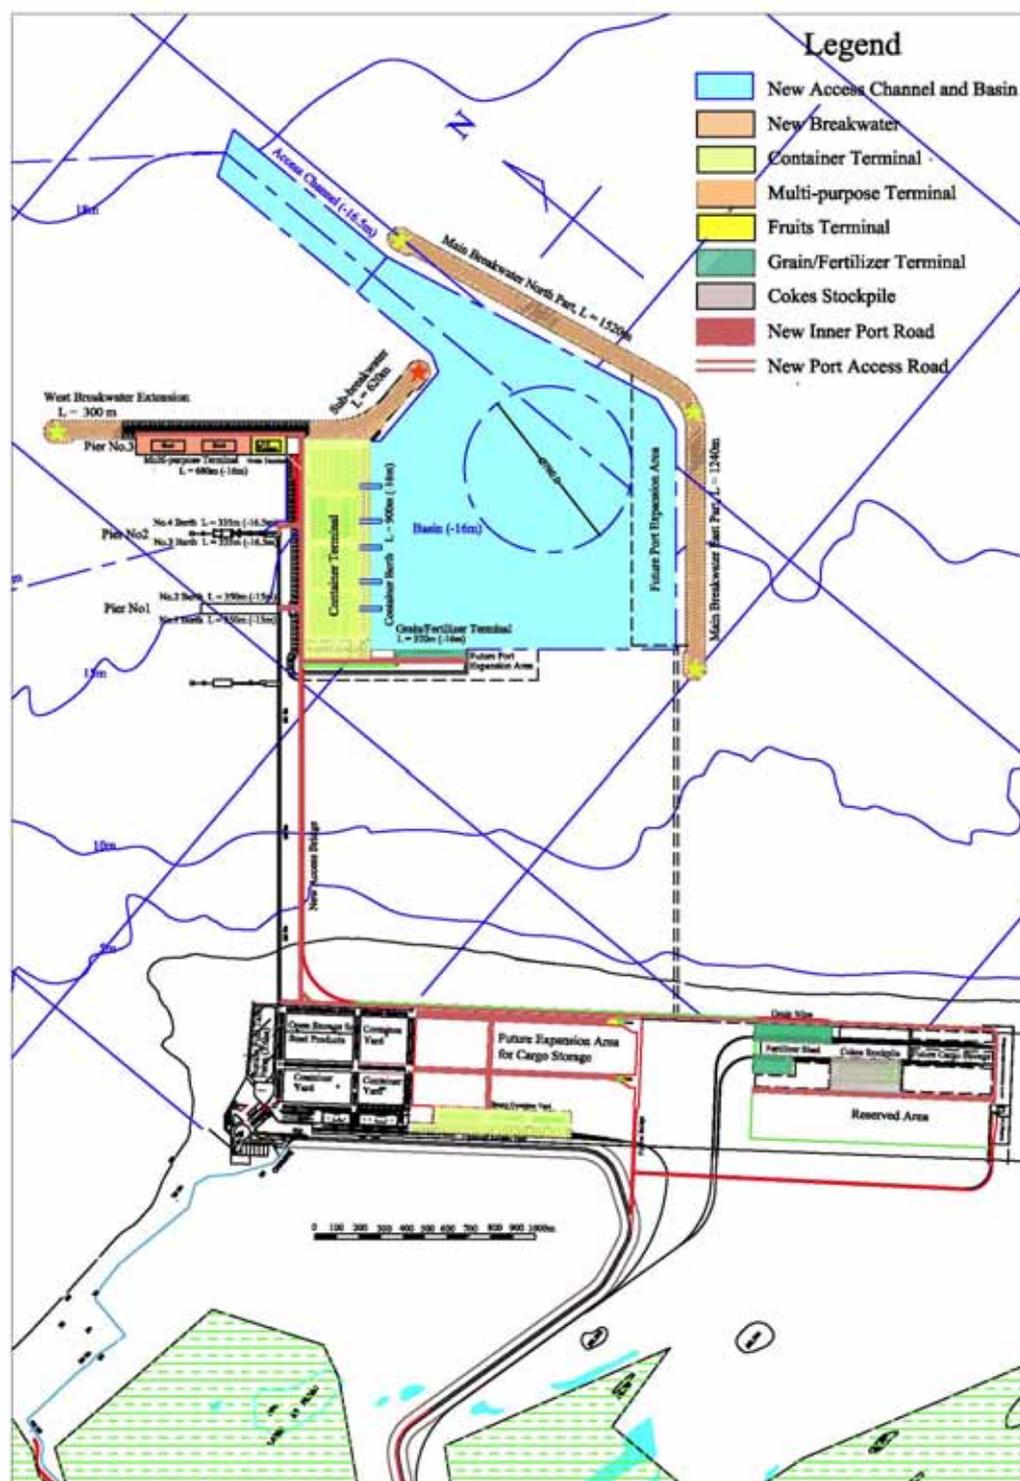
Projeto de *Layout* da Instalação no Plano de Longo Prazo
